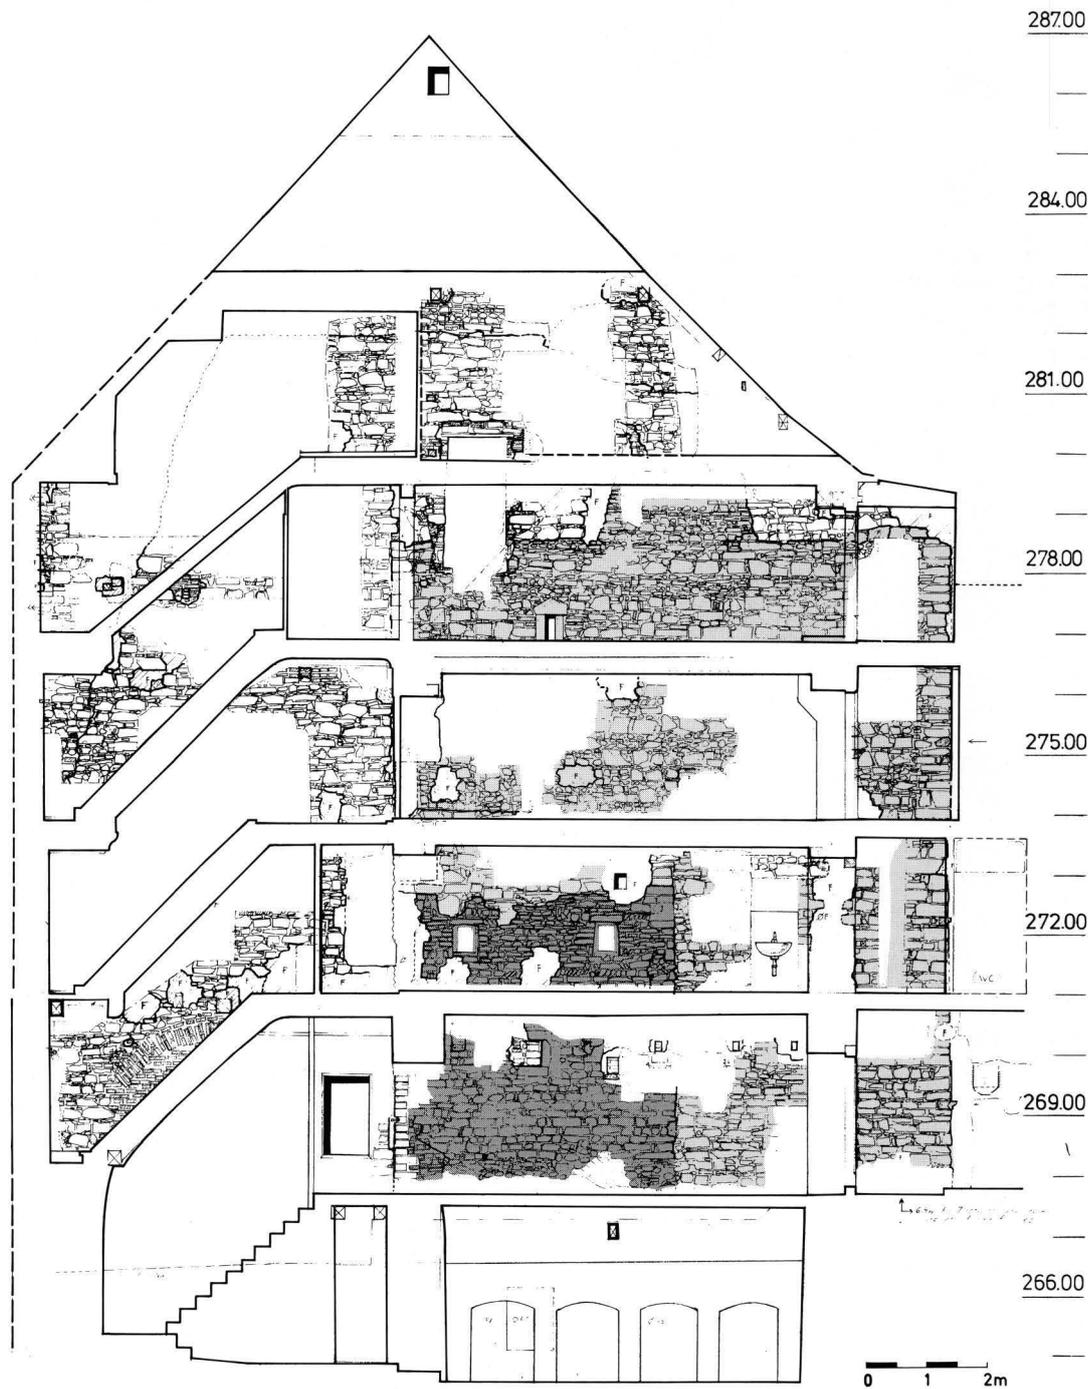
Bäumleingasse 14. Östliche Brandmauer mit den Befunden. – Zeichnung: S. Tramèr. – Masstab 1:125.
